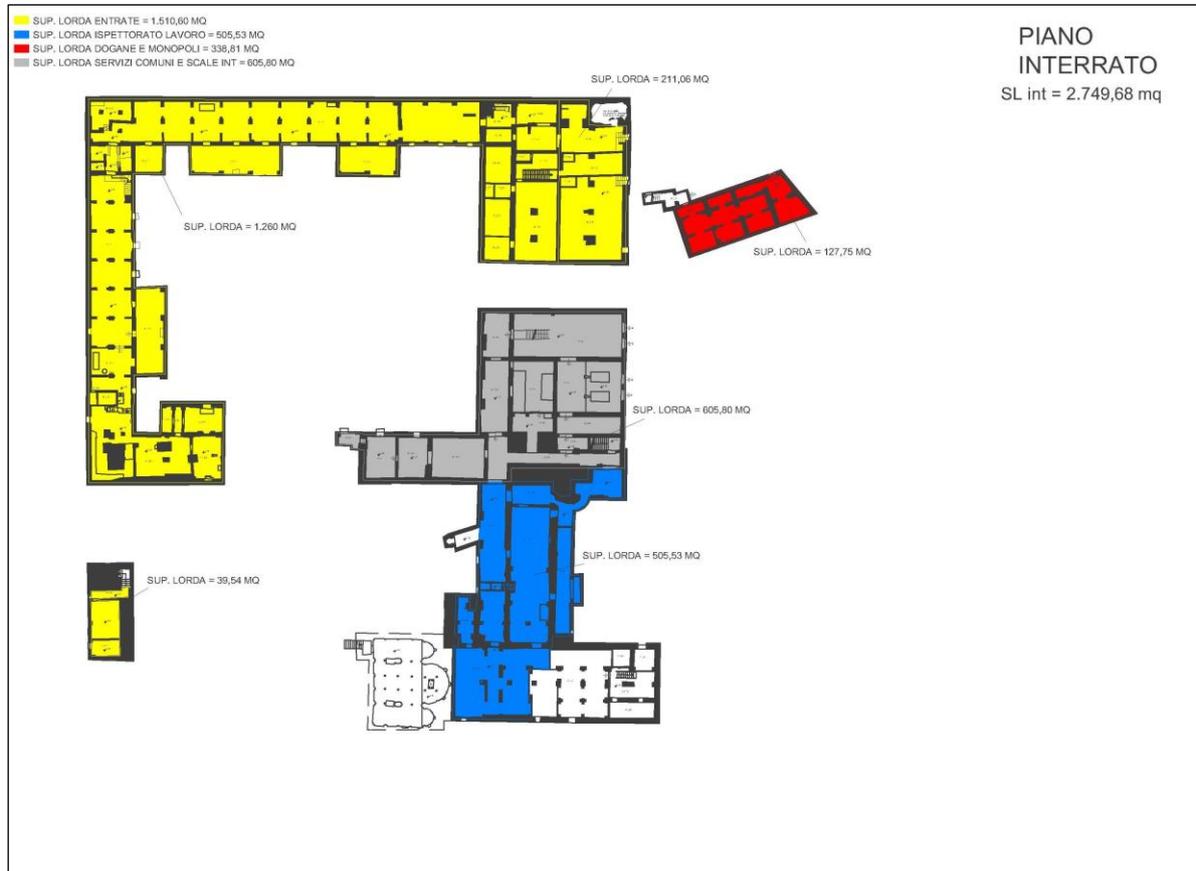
Piano di razionalizzazione (2019) – pianta del piano interrato
